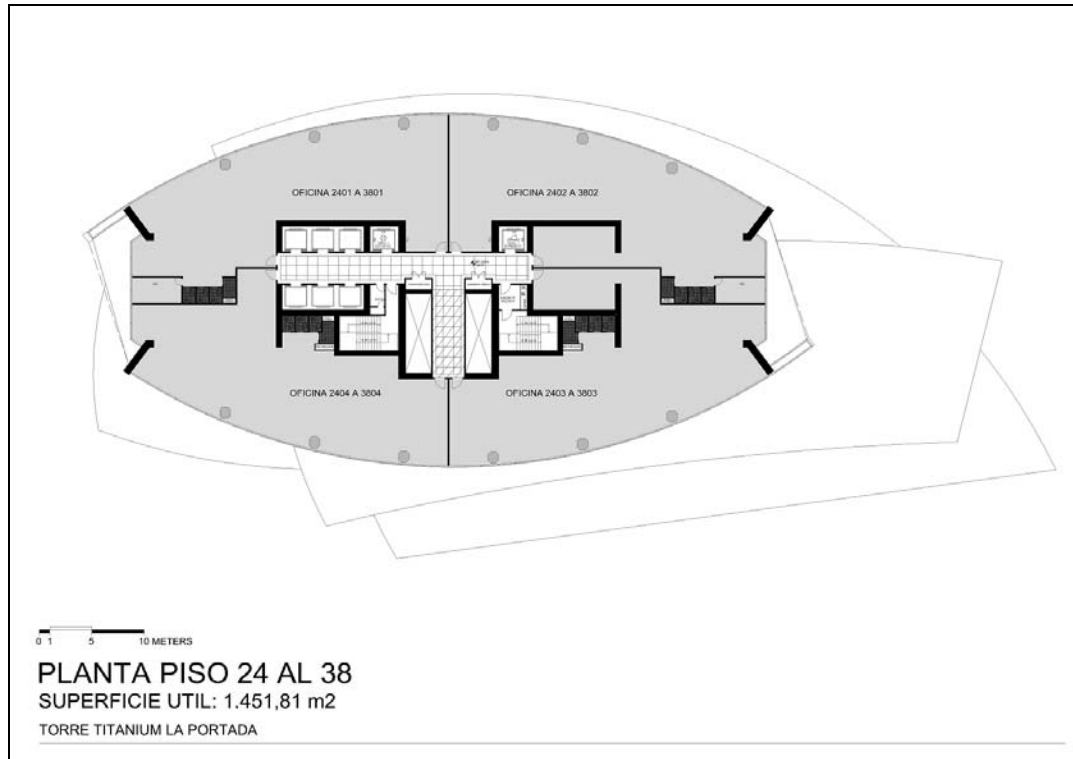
7. Planta Pisos 24 al 38. Fuente: ASL Sencorp.
